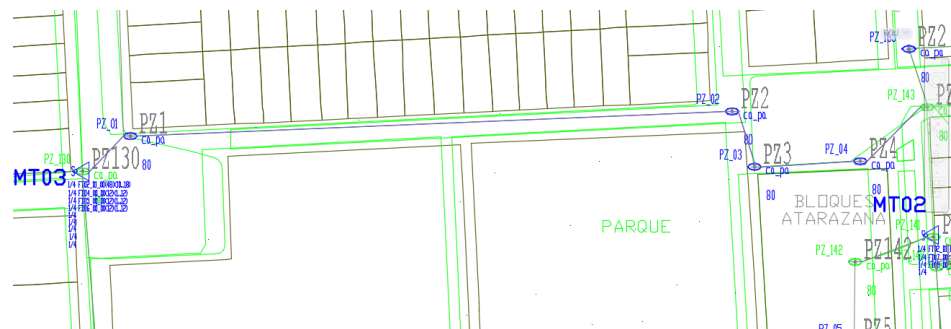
Pozos proyectados entre mangas MT02 y MT03.
